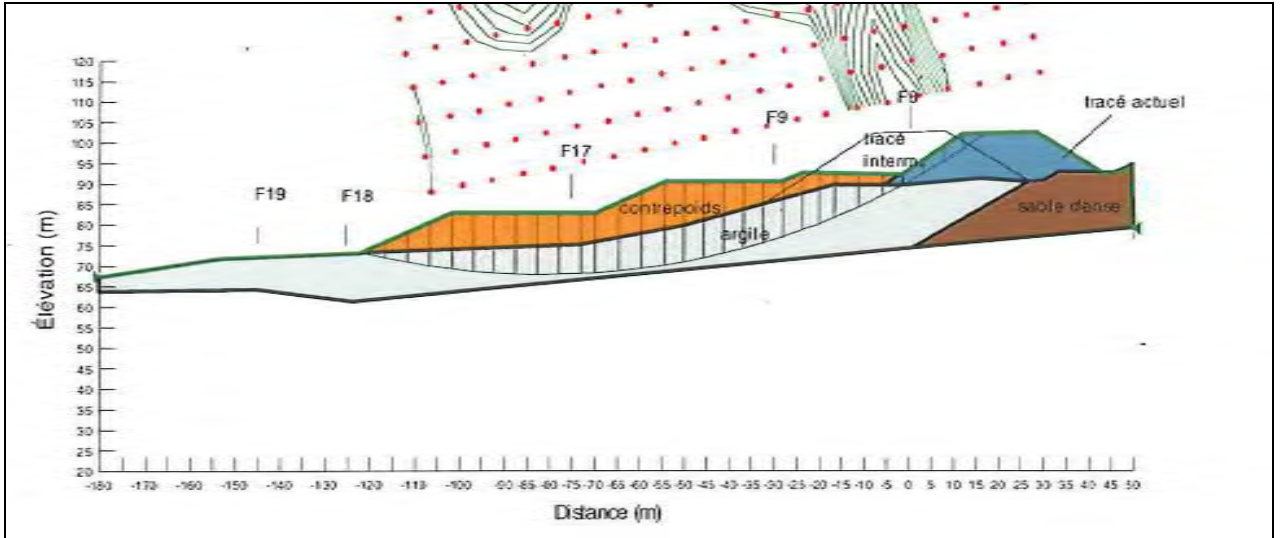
Vue en plan du contrepoids à trois paliers - tracé intermédiaire
